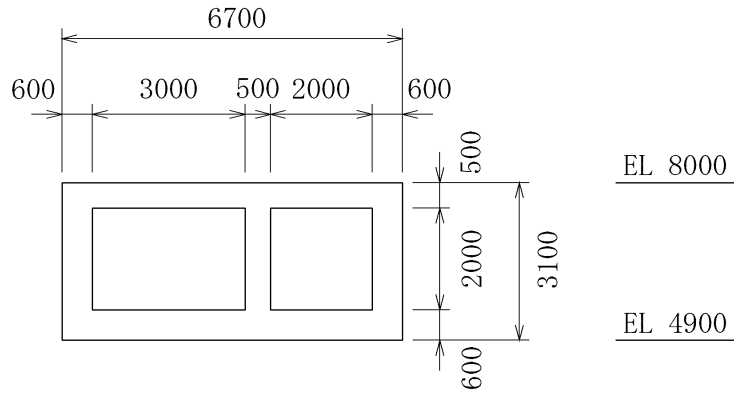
屋外配管ダクト（タービン建物～排気筒） 平面図
